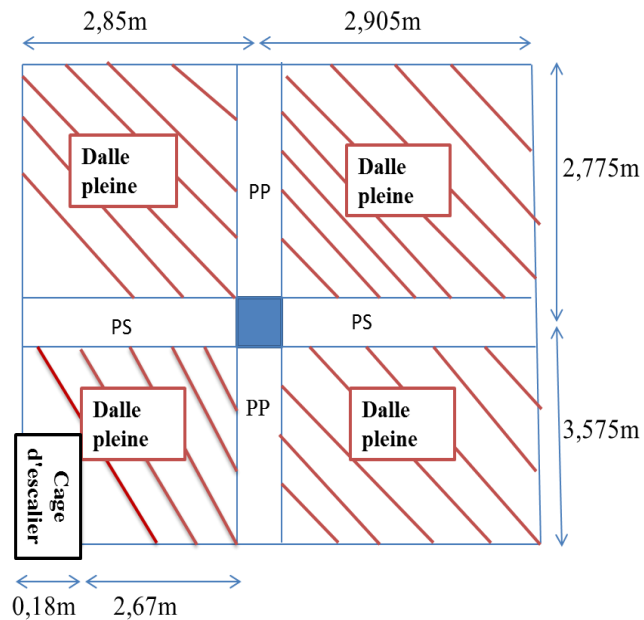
la surface supporte par le poteau central (niveau RDC).
